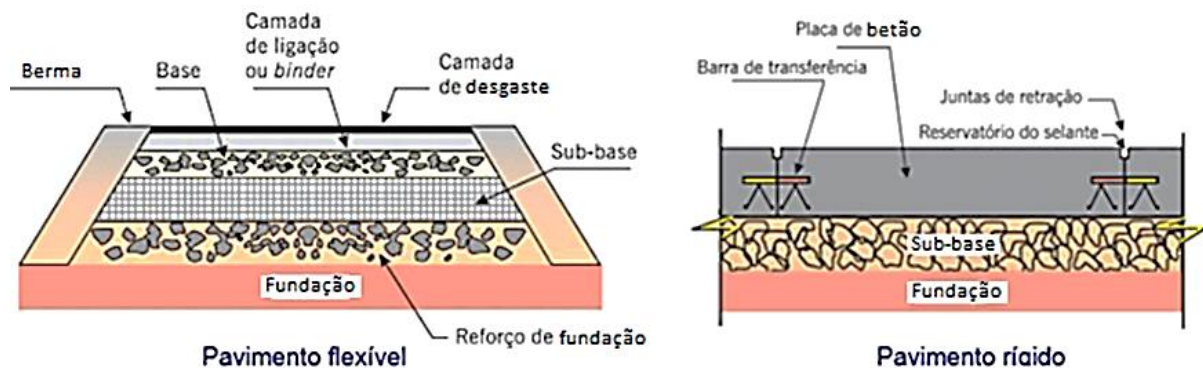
Comparação entre camadas constituintes de um pavimento flexível e de um pavimento rígido (adaptado de Bernucci *et al.*, 2010)
